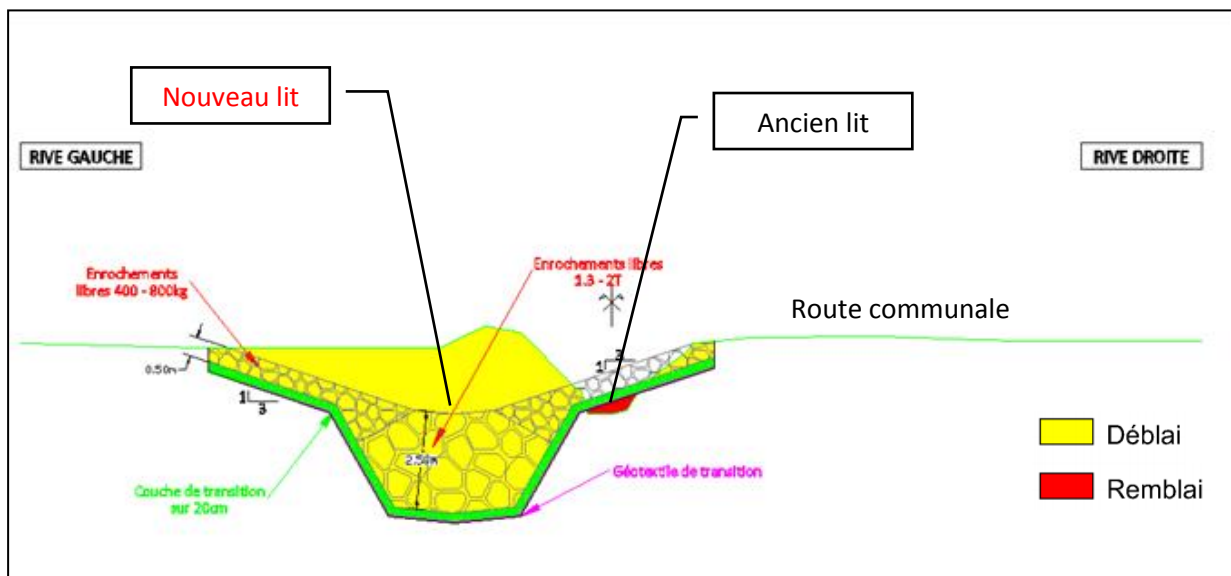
Coupe type du seuil de calage de fond avant et après aménagement
